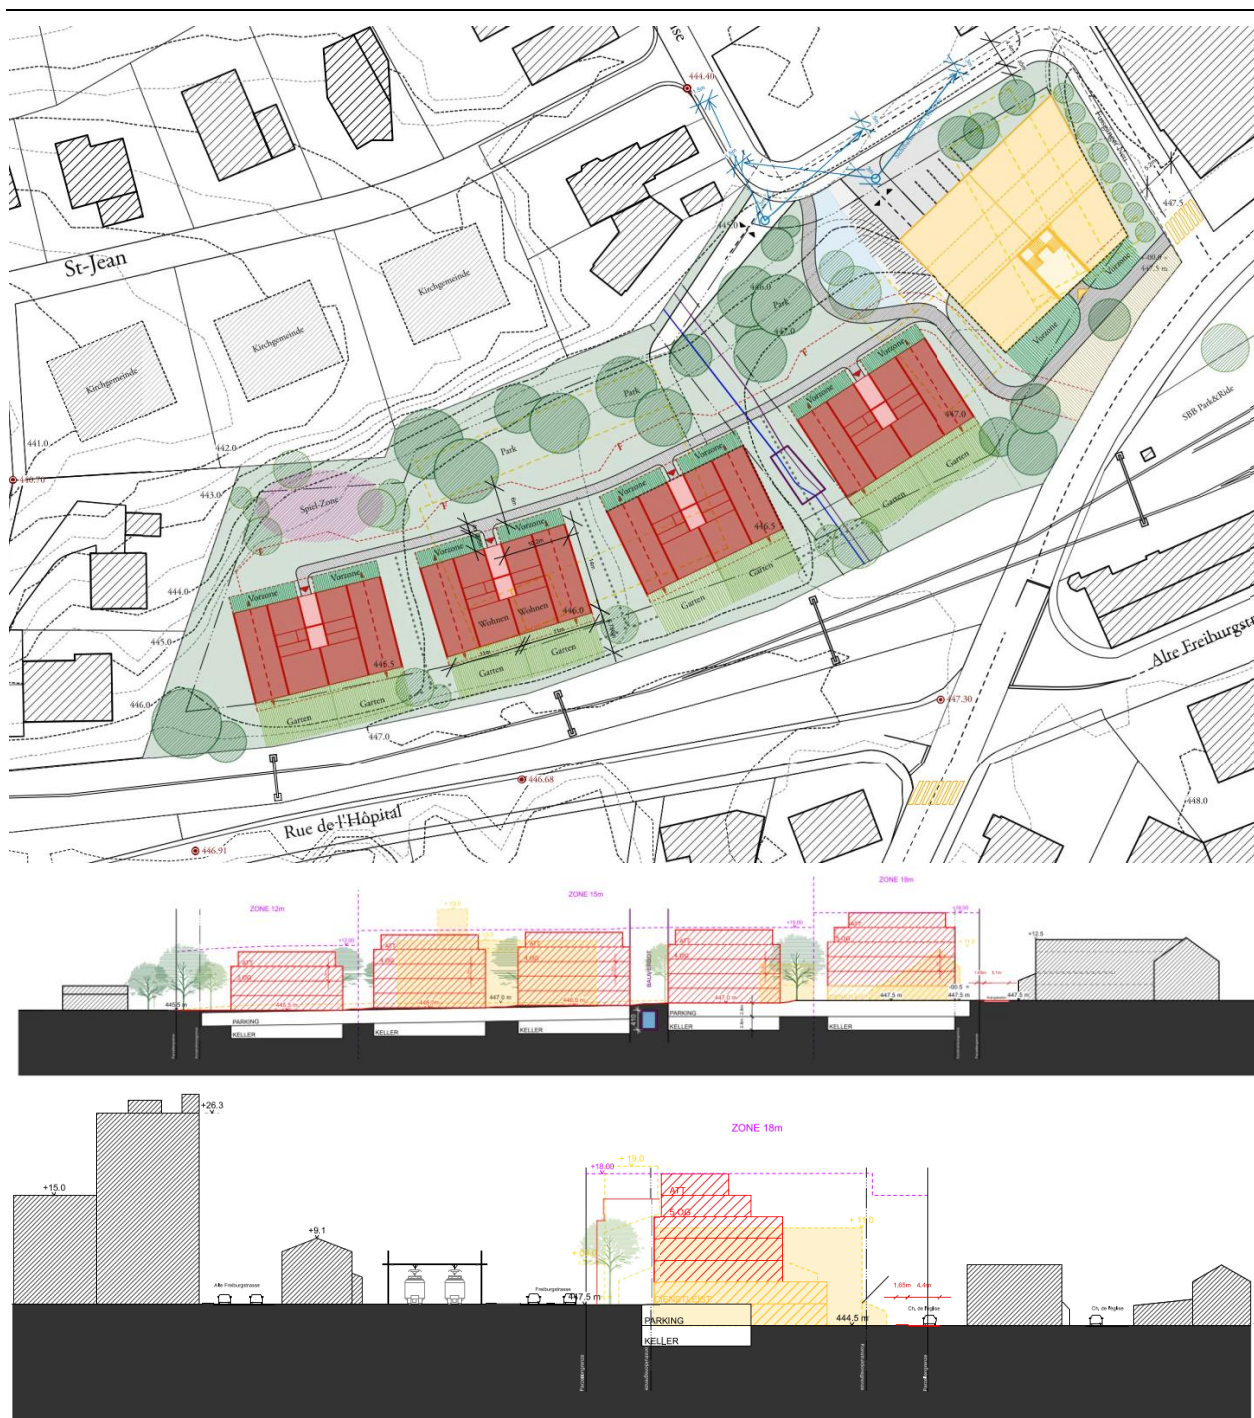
Richtprojekt «Saatzucht» mit Situationsplan, Längsschnitt und Querschnitt durch Punktbau
